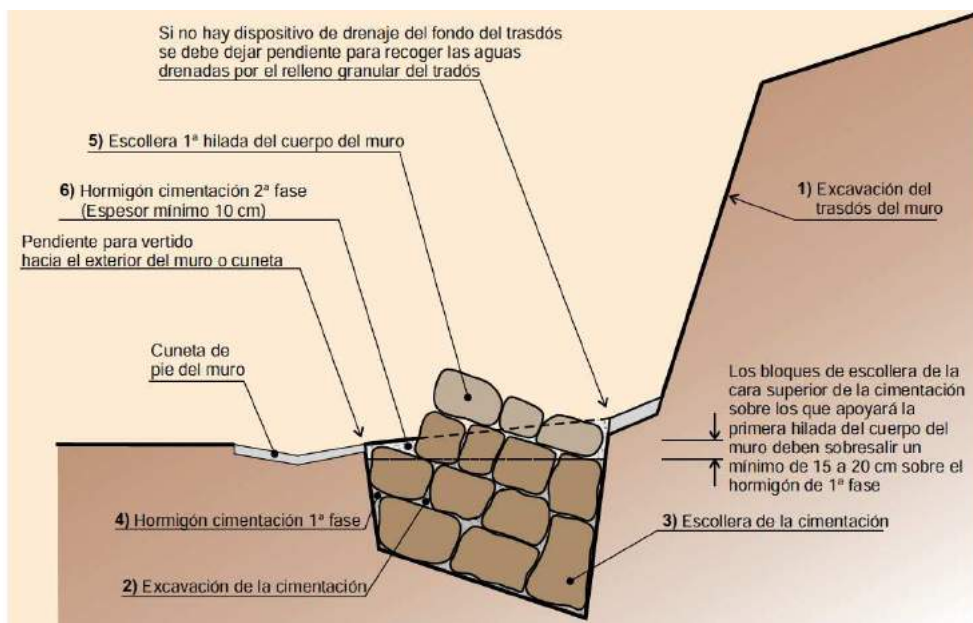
FASES DE EJECUCIÓN DE LA CIMENTACIÓN
